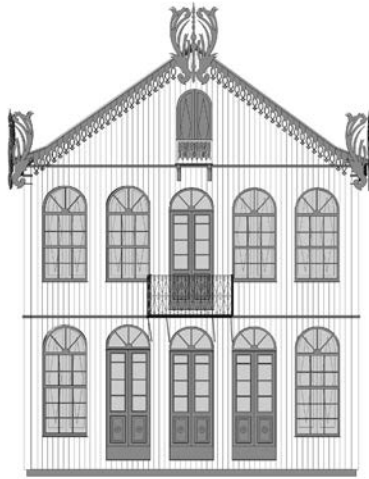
Casa Bocchese, fachada Calle Luiza Bocchese, orientación este. FIG. 3.9.15: Casa Bocchese, fachada posterior, orientación oeste. FIG.3.9.16 y FIG.3.9.17: Casa Bocchese , fachadas laterales orientación norte y sur, respectivamente. Dibujos de la autora.
